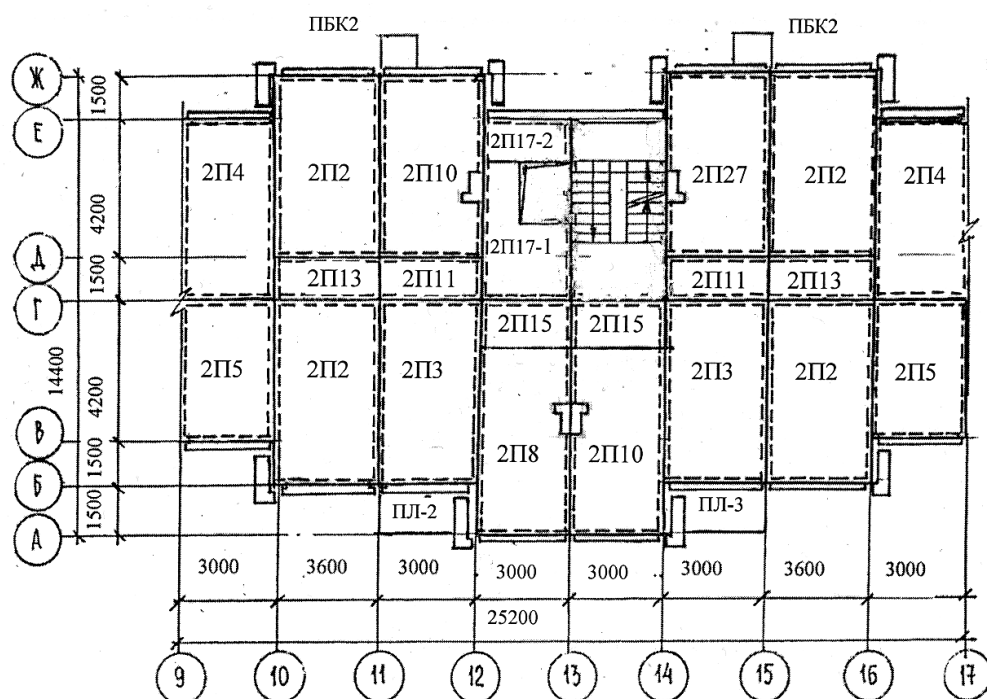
Схема расположения железобетонных элементов перекрытия типового этажа (типовая серия 90-0104.13.86)
